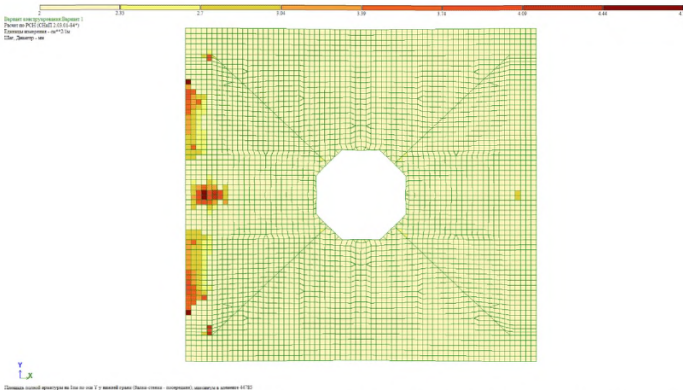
ЛР №3. Нижнее армирование складчатого покрытия по оси  $Y$
